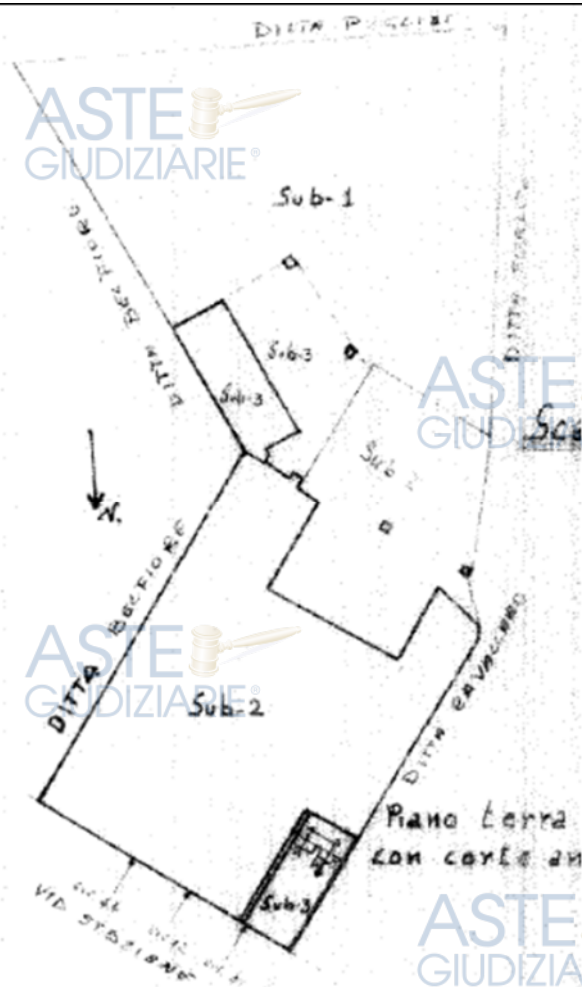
Elaborato planimetrico distribuzione sub al piano terra
